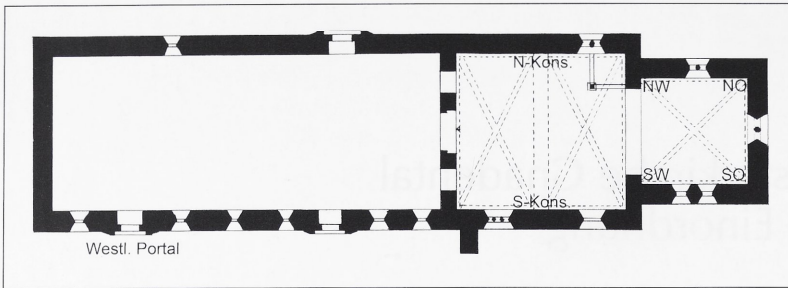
(ganz oben): Gnadental. Grundriss der Klosterkirche.
